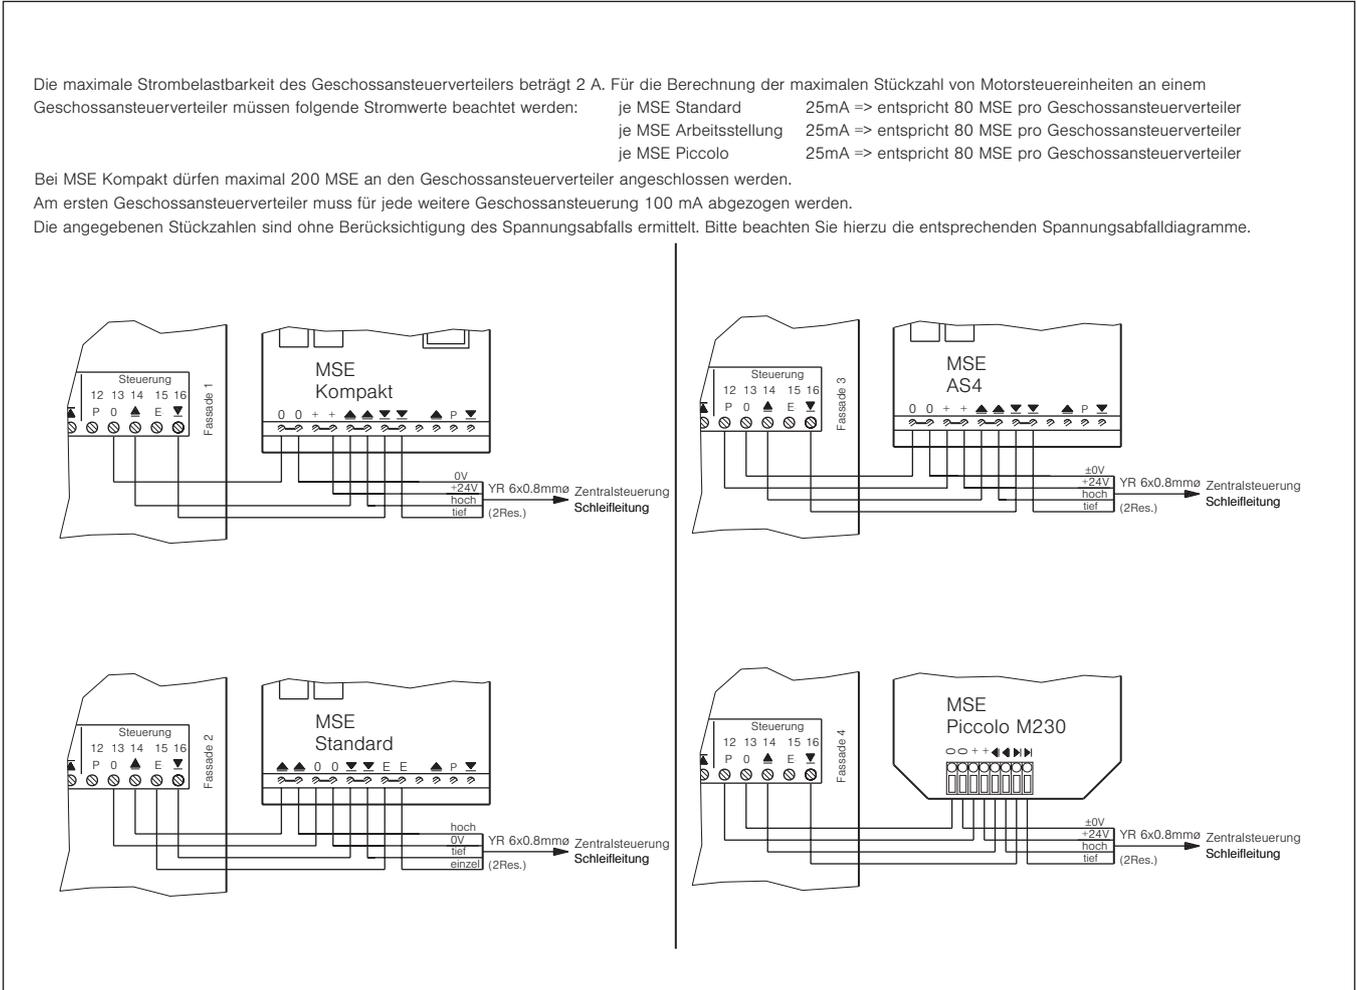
Anschlussplan Geschossansteuerung an MSE
